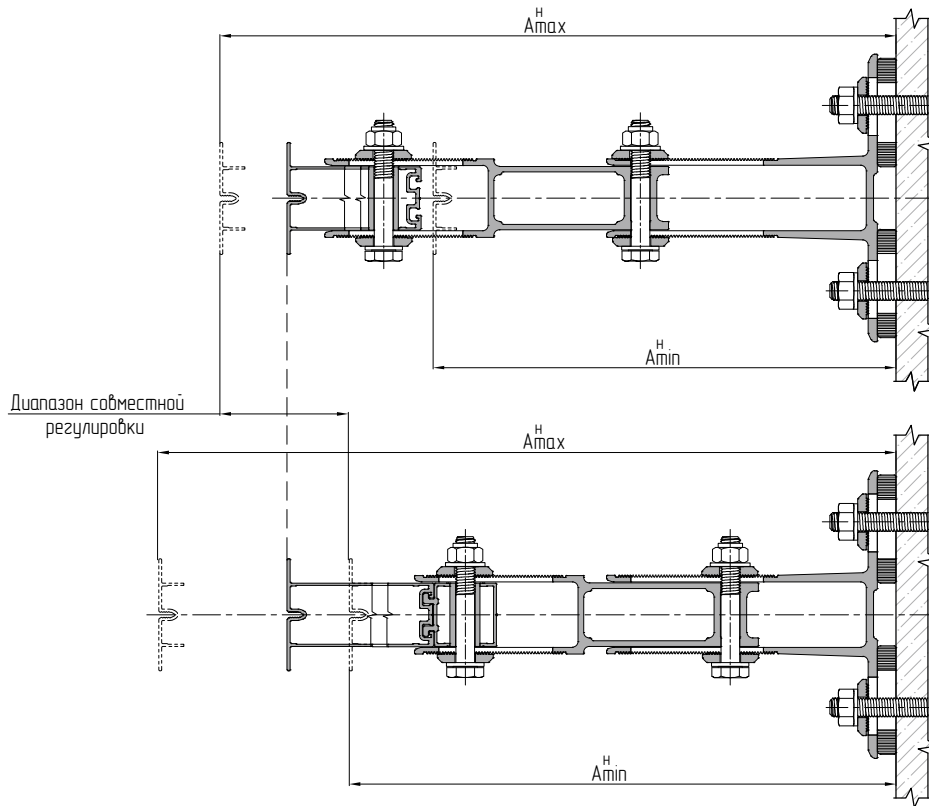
Рисунок VI – для схем сопряжения 6 и 14, схем 8 и 14, схем 8 и 16, схем 14 и 22, схем 16 и 22, схем 16 и 24
